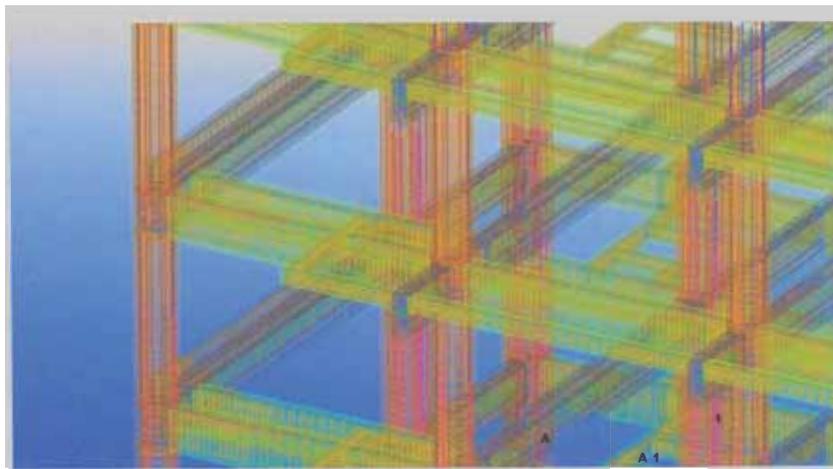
Detallamiento de acero de refuerzo en Tekla Structures
